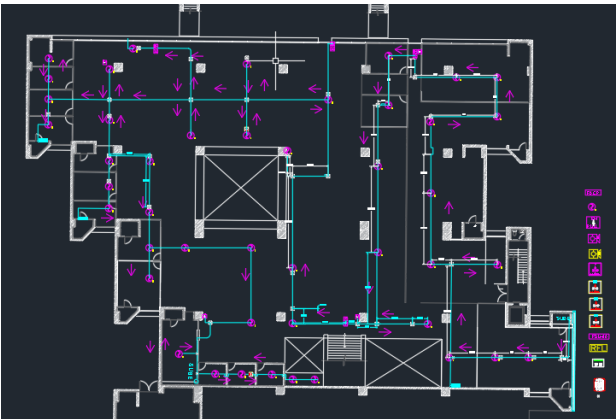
Plano de Planta Baja de la Biblioteca “Dr. Ramón Villarreal Pérez” con las correcciones del levantamiento de la Instalación de Detección de Humos.
